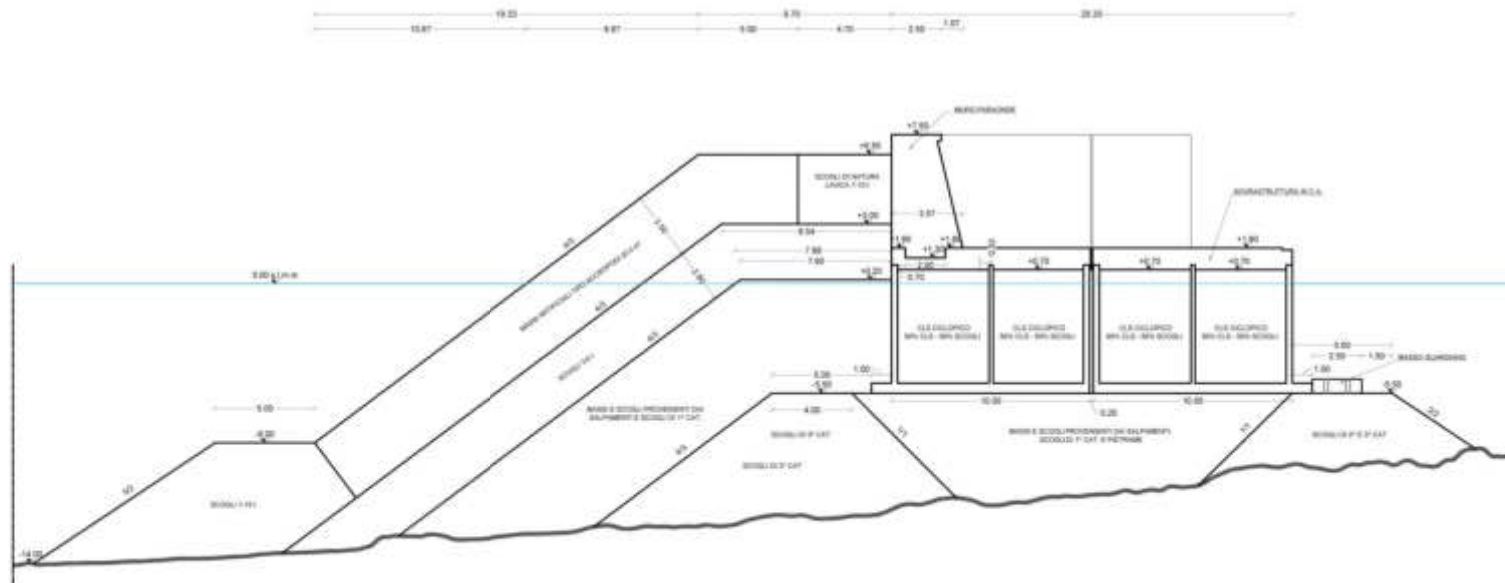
Sezione tipo dalla progr. 122.80 m alla progr. 140.80 m
